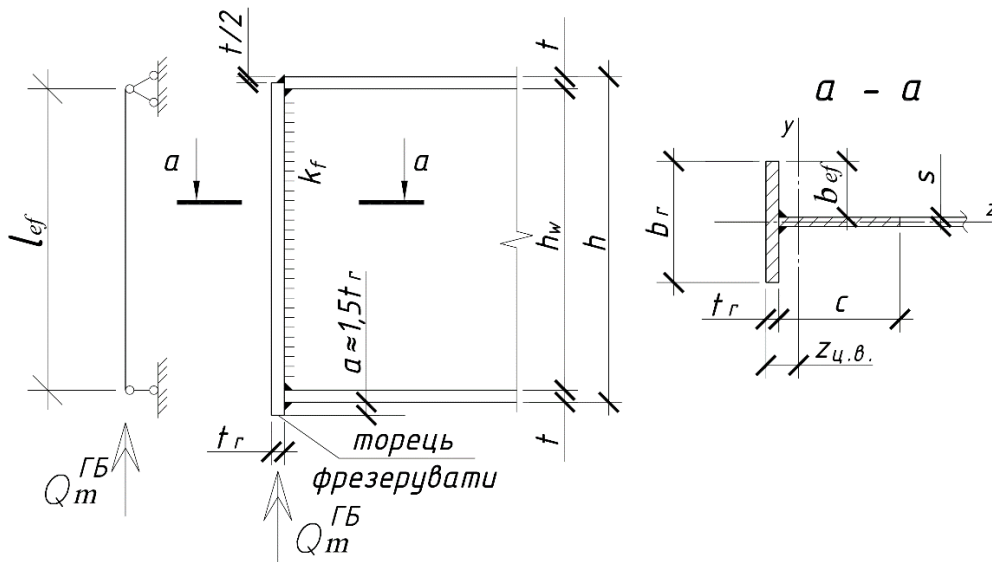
Конструкція та розрахункова схема торцевого опорного ребра головної балки
